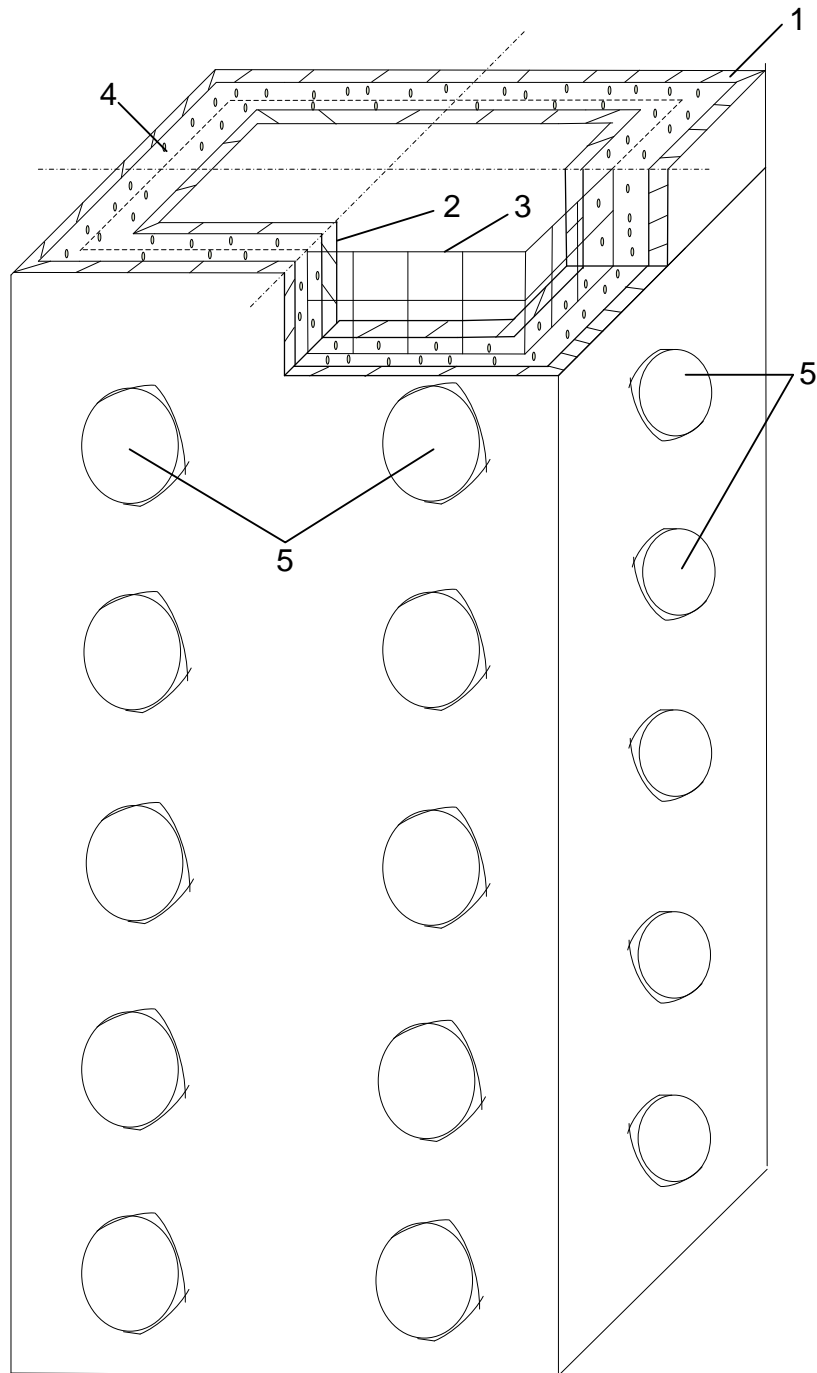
Конструкция опалубки с индукционным нагревом для изготовления железобетонных элементов дымоудаления типа ШДЦ 12: 1 – наружная часть стальной опалубки; 2 – внутренняя часть стальной опалубки; 3 – арматура в виде плоской стальной сетки; 4 – бетон; 5 – индукторы на поверхности стальной опалубки
